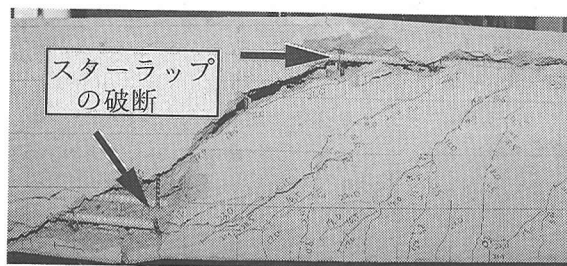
破壊時のひび割れ状況 (No.12)
